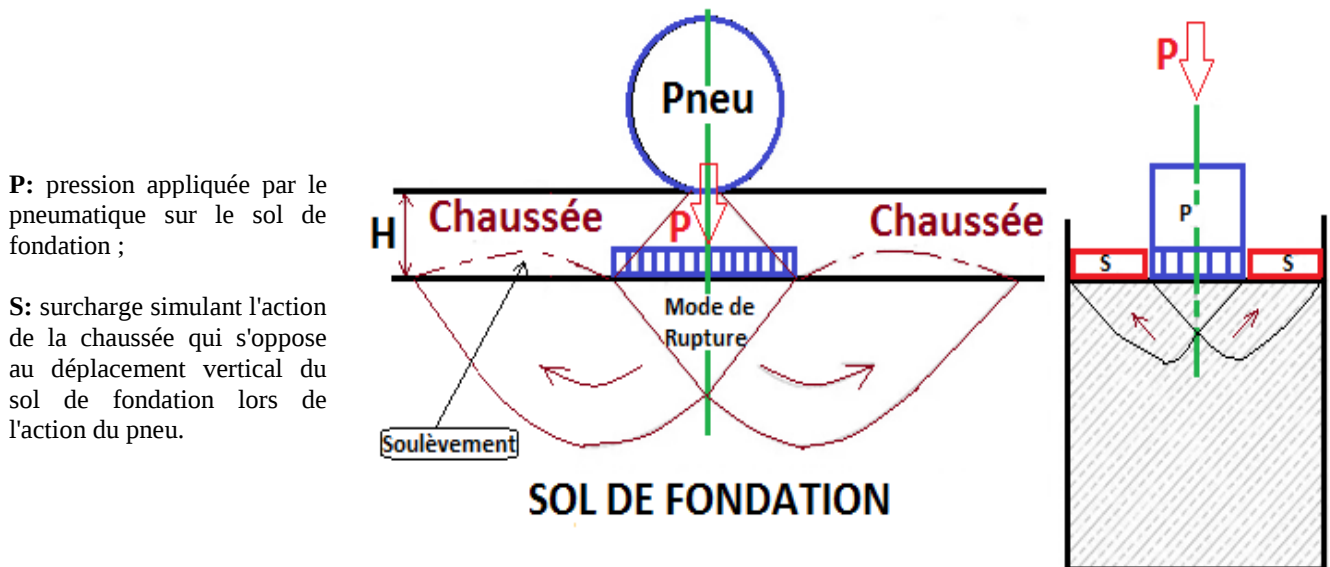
Essai CBR simulant le phénomène de poinçonnement dans une chaussée routière.
